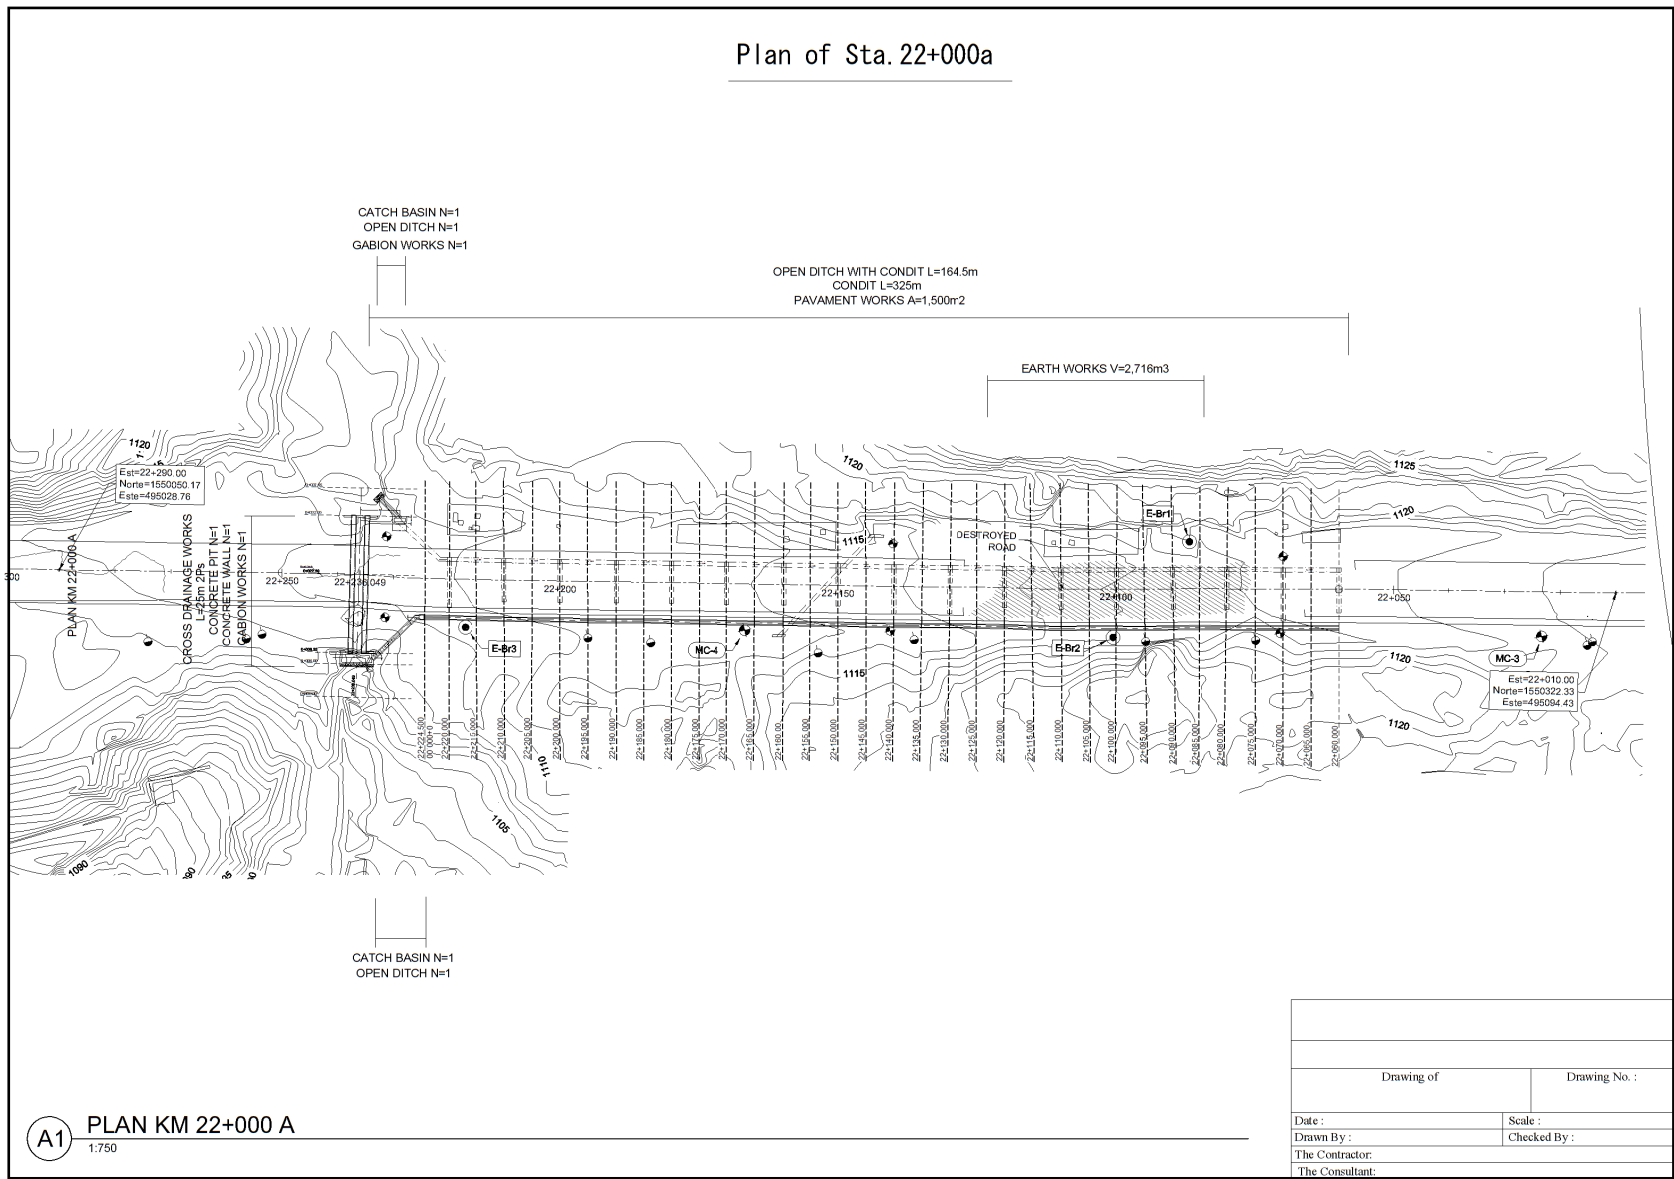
Sta. 22+000a 平面図 (Non-Scale)
